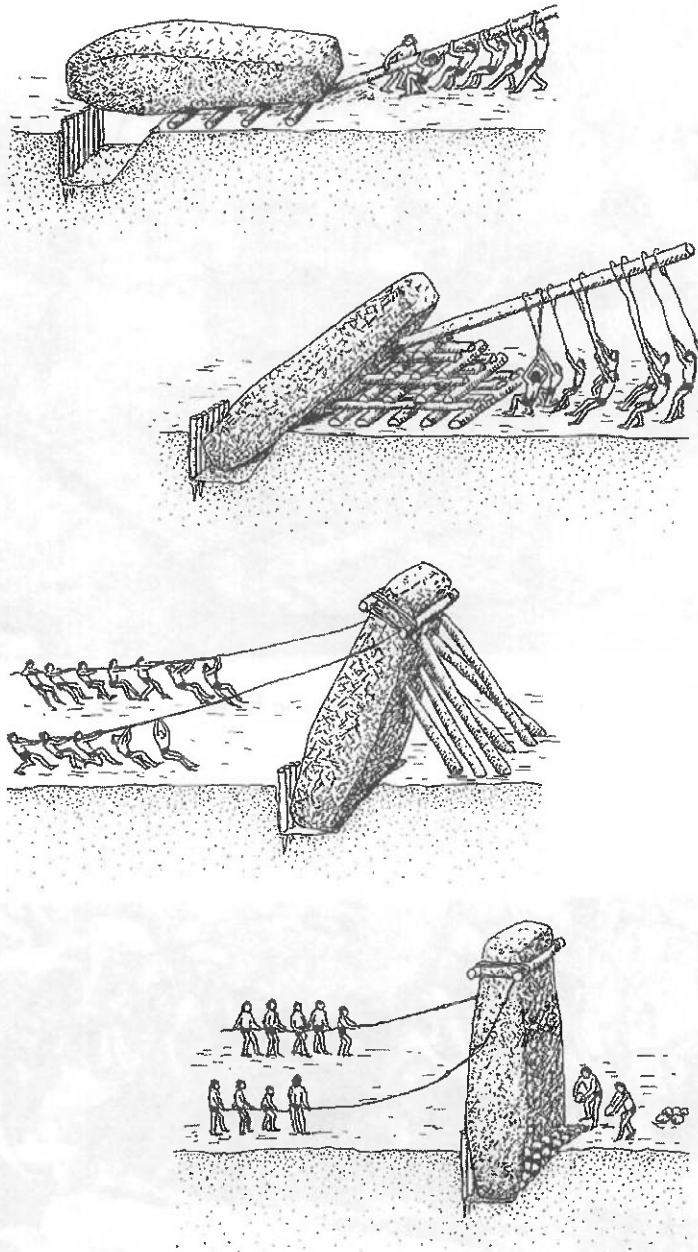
d Sistema de levantamiento de piedras verticales
